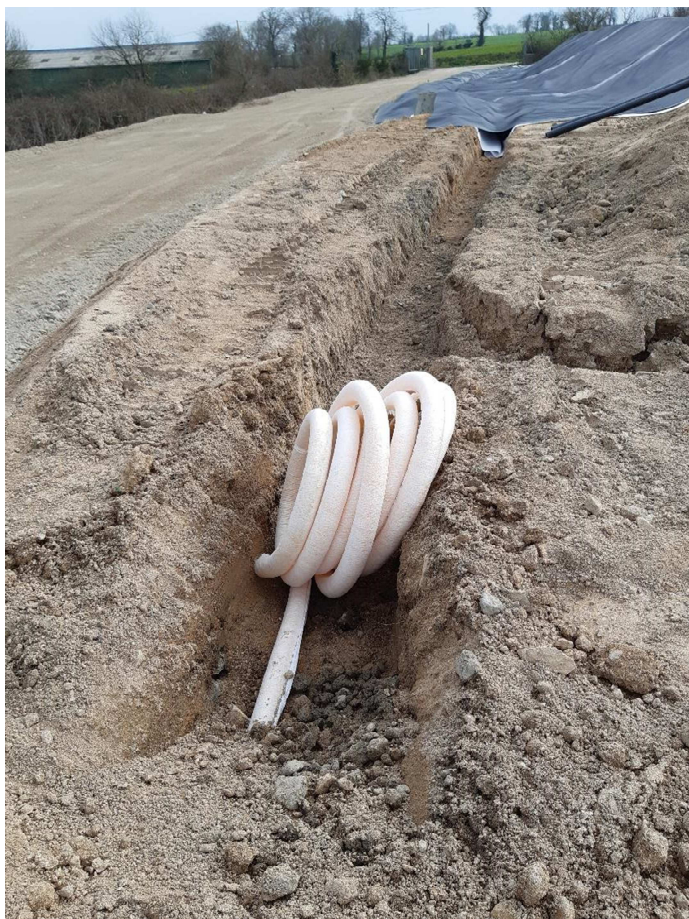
mise ne place drain raccordé à la tranchée drainante
